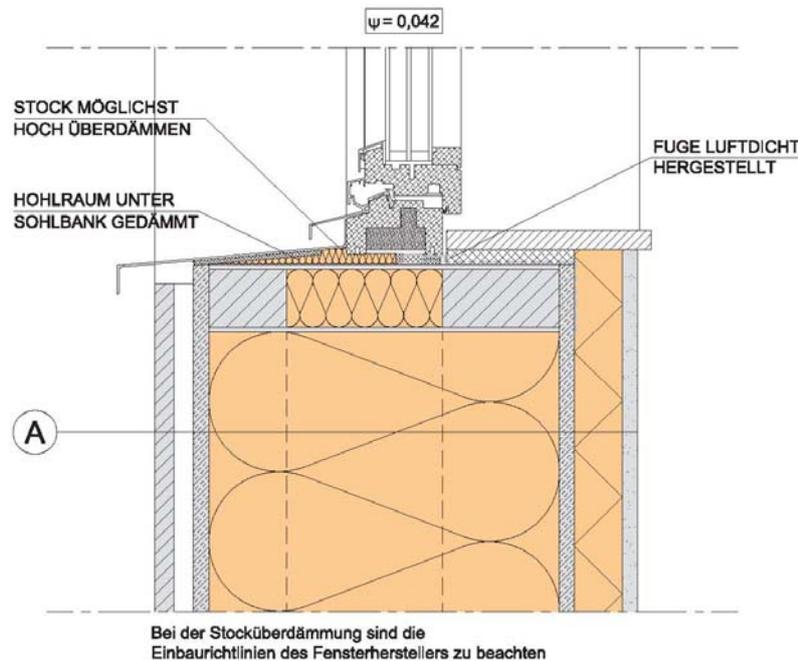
Außenwandaufbau mit Fensteranschluss (Skelettbauweise) [http://www.gdi.at/gdi_passivhaus_details.pdf, Abgerufen am 25.11.2007]
